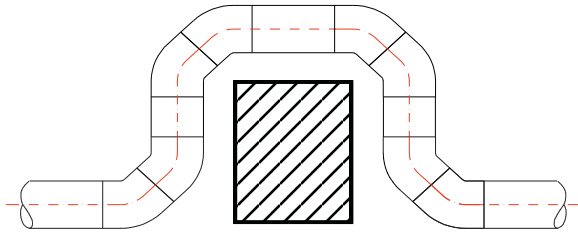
Nachträglicher Einbau von acht zusätzlichen 45°-Bögen in eine Druckentwässerungsanlage (Draufsicht)
